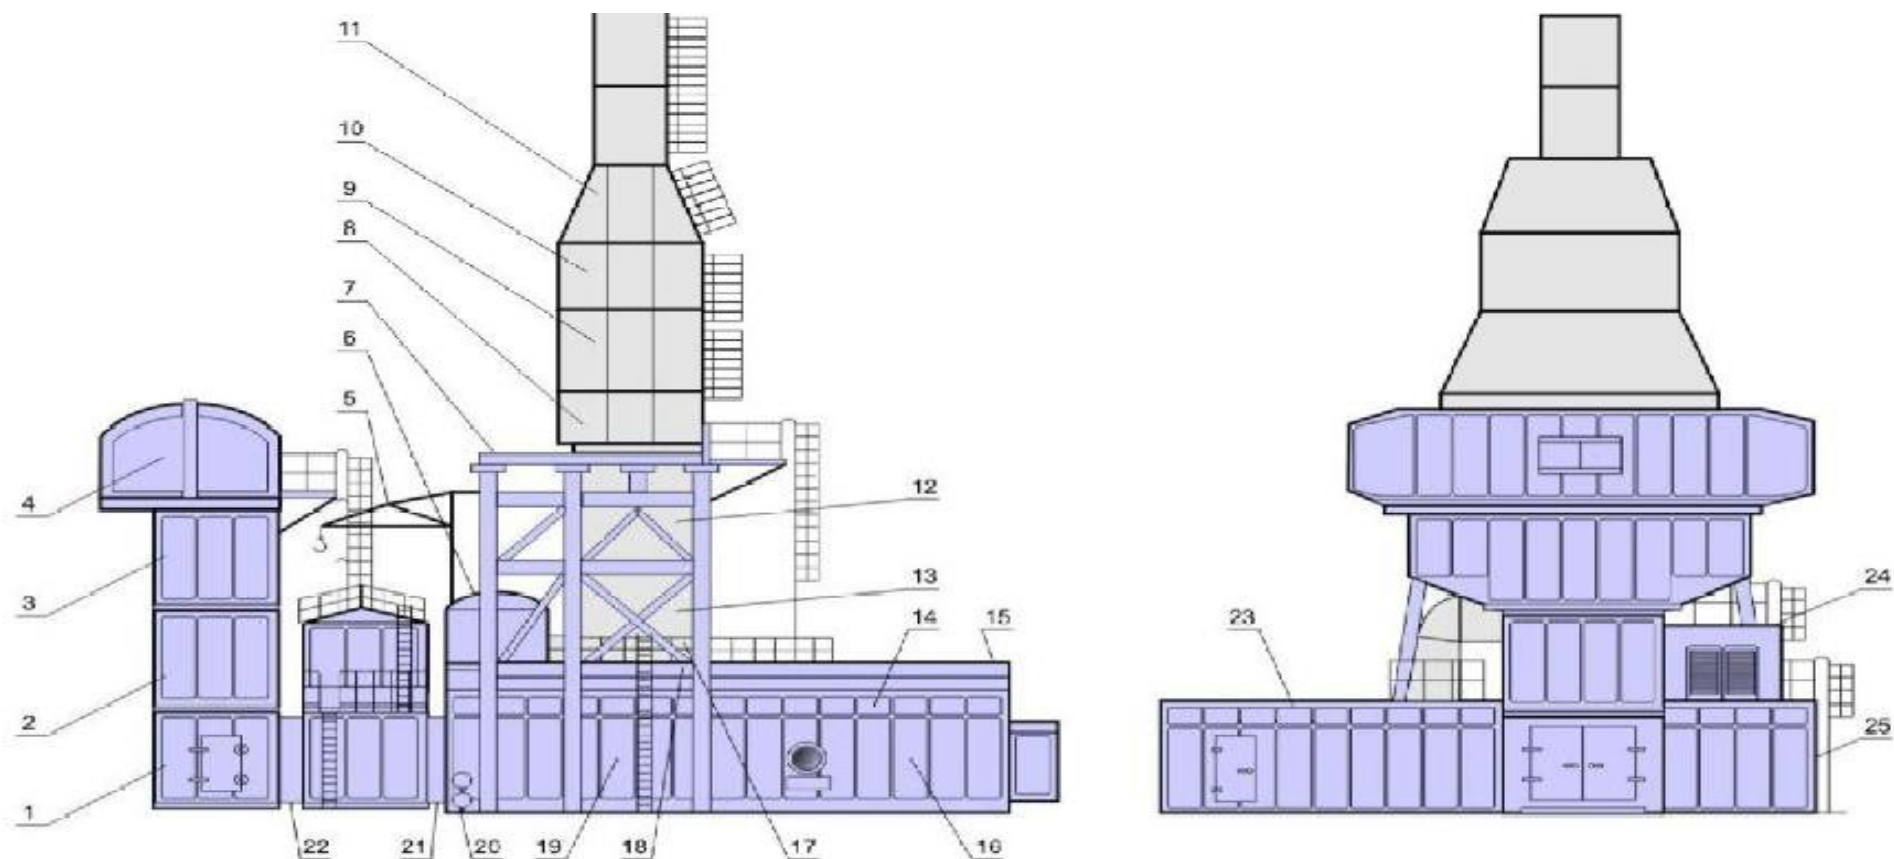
Устройство агрегата газоперекачивающего ГПА-Ц5-16:
